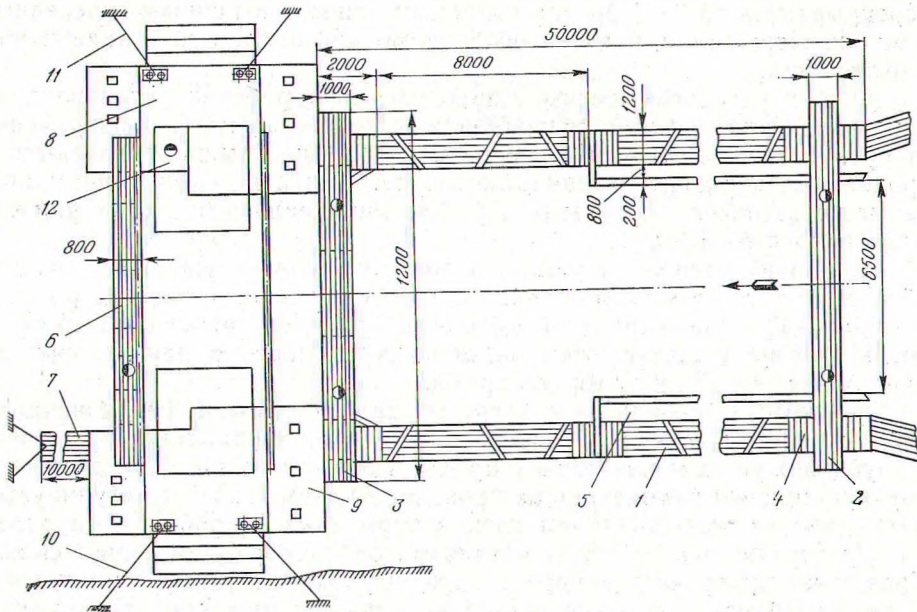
1 — подводящий коридор; 2 — переходный мостик; 3 — рабочий мостик; 4 — сходни; 5 — продольный коридор; 6 — переходной мостик; 7 — шестибревенный бон; 8 — понтон с двигателем; 9 — понтон с намоточным механизмом; 10 — береговые опоры; 11 — русловые опоры; 12 — рубка; ○ — размещение рабочих.
